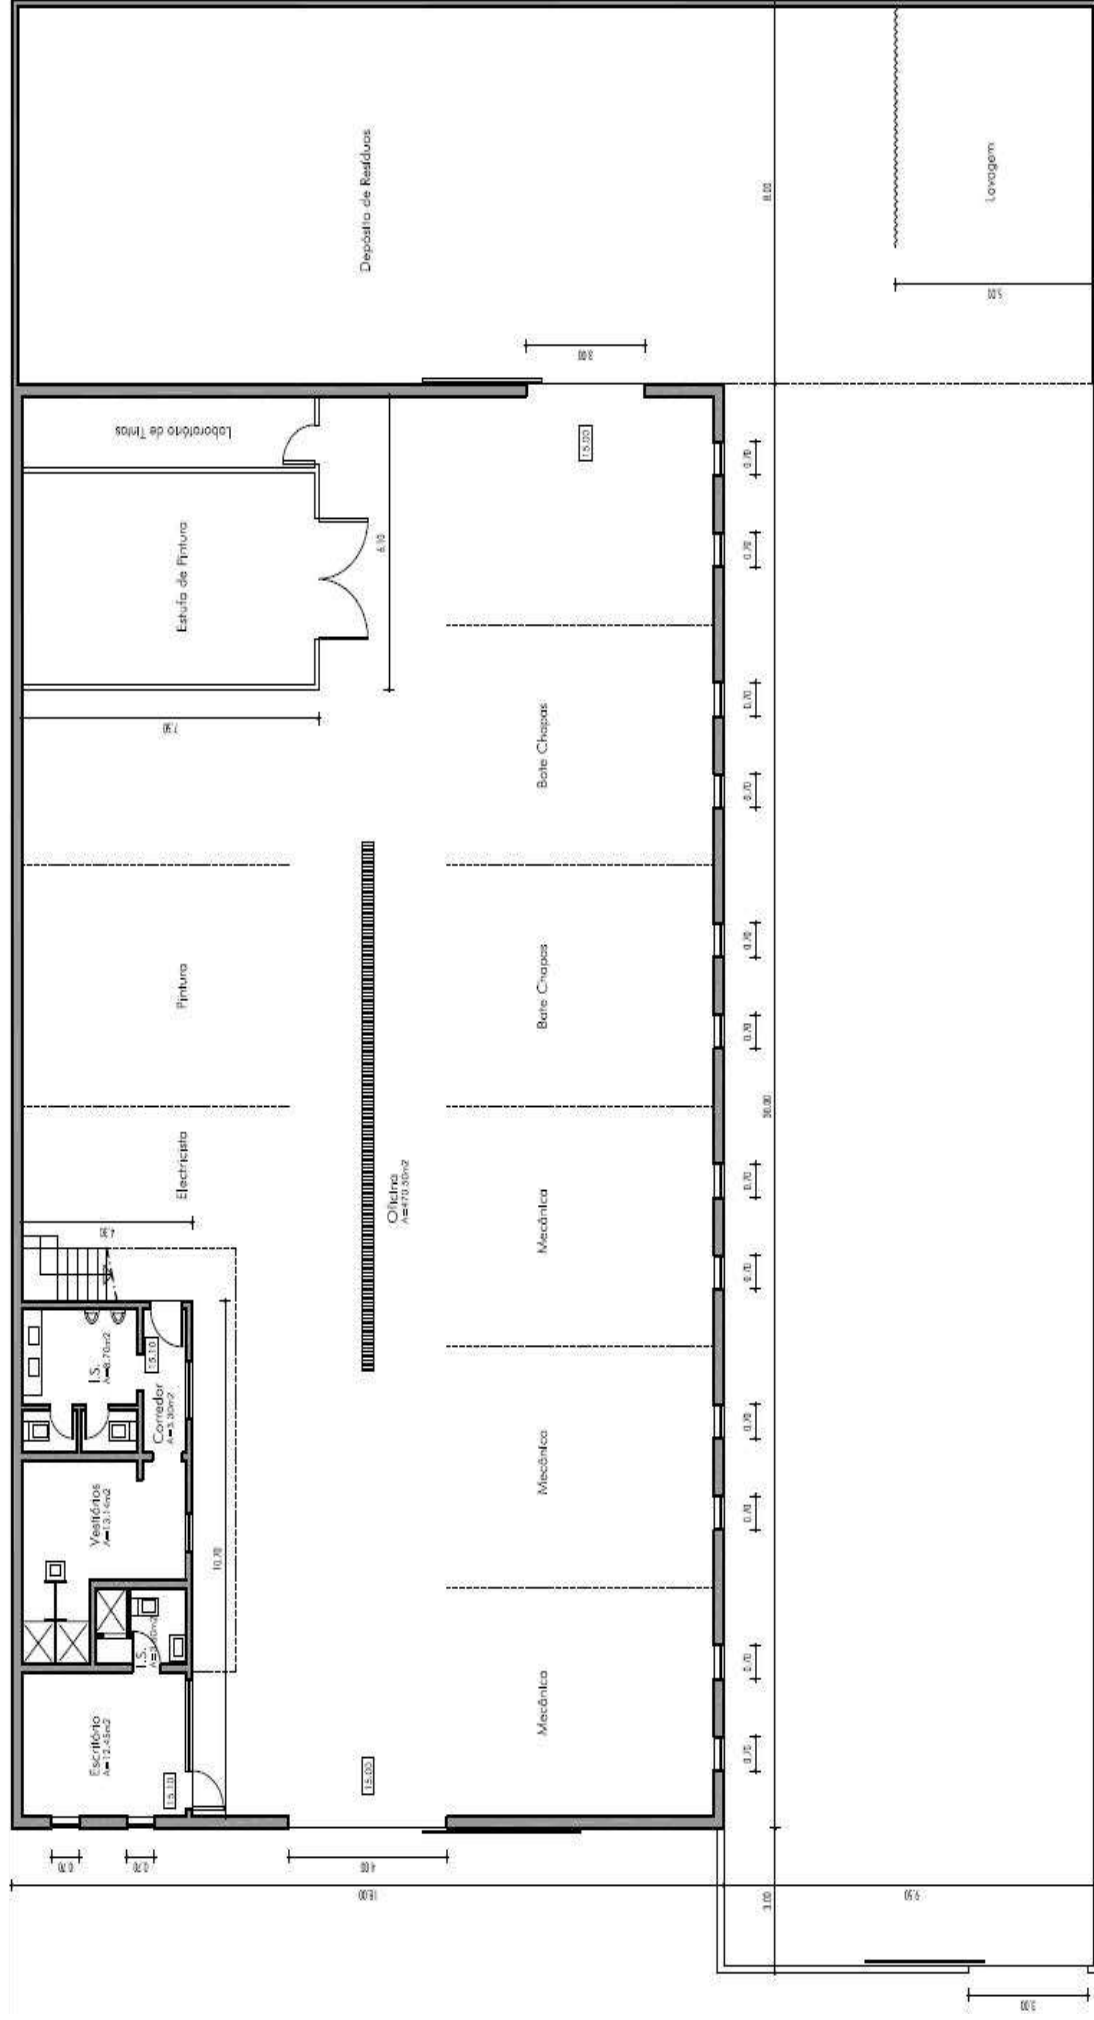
Planta das instalações da oficina Auto D. Sebastião
